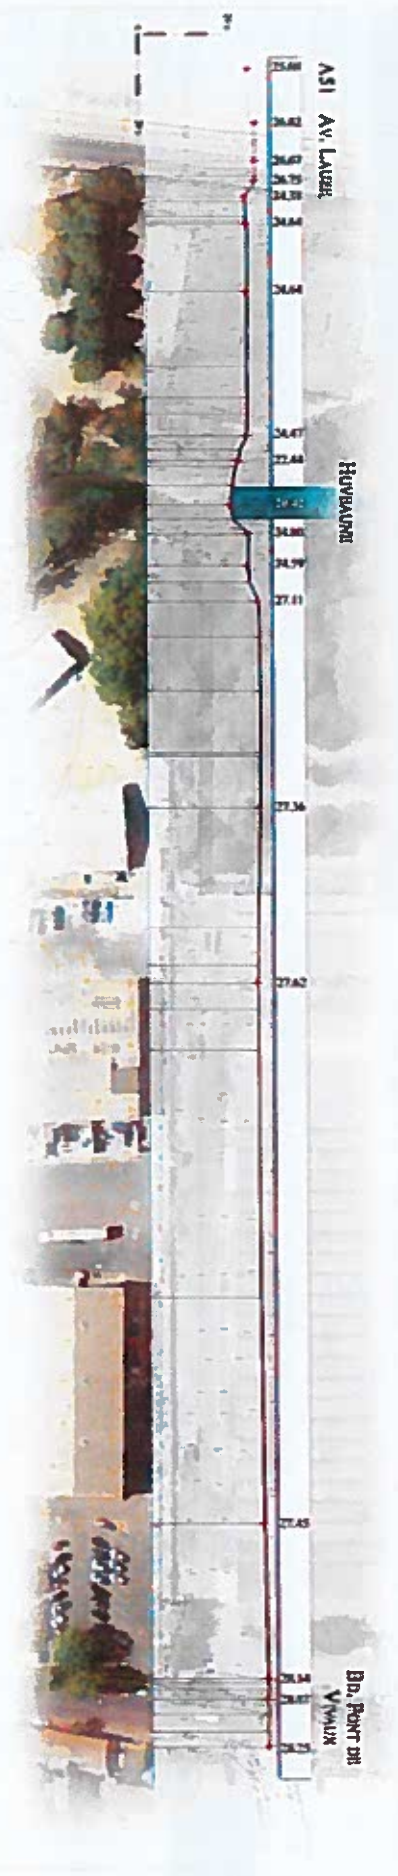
Coupe topographique de l'existant au niveau de la future voie U424
